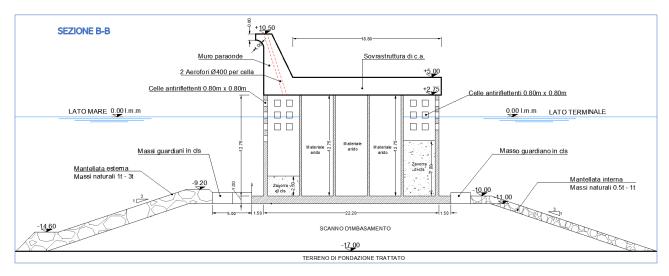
Sezione corrente della diga foranea con le celle antiriflettenti poste sui due lati longitudinali della struttura.
